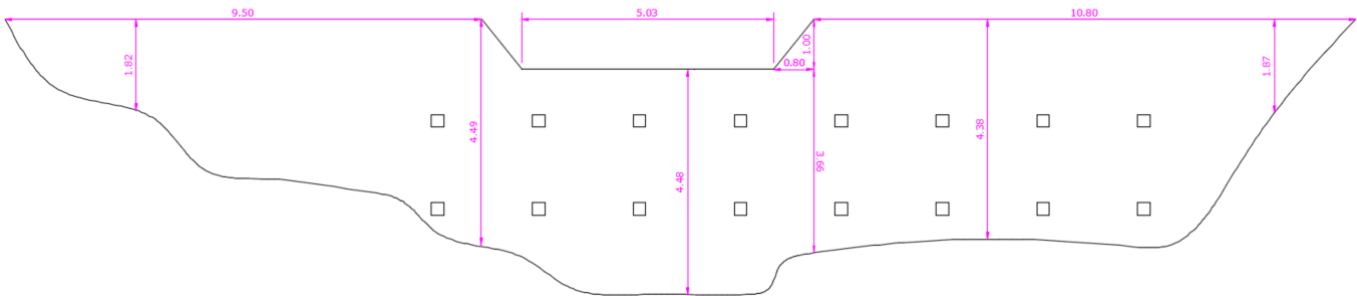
Schéma caractéristique - Élévation aval de l'ouvrage BA004
